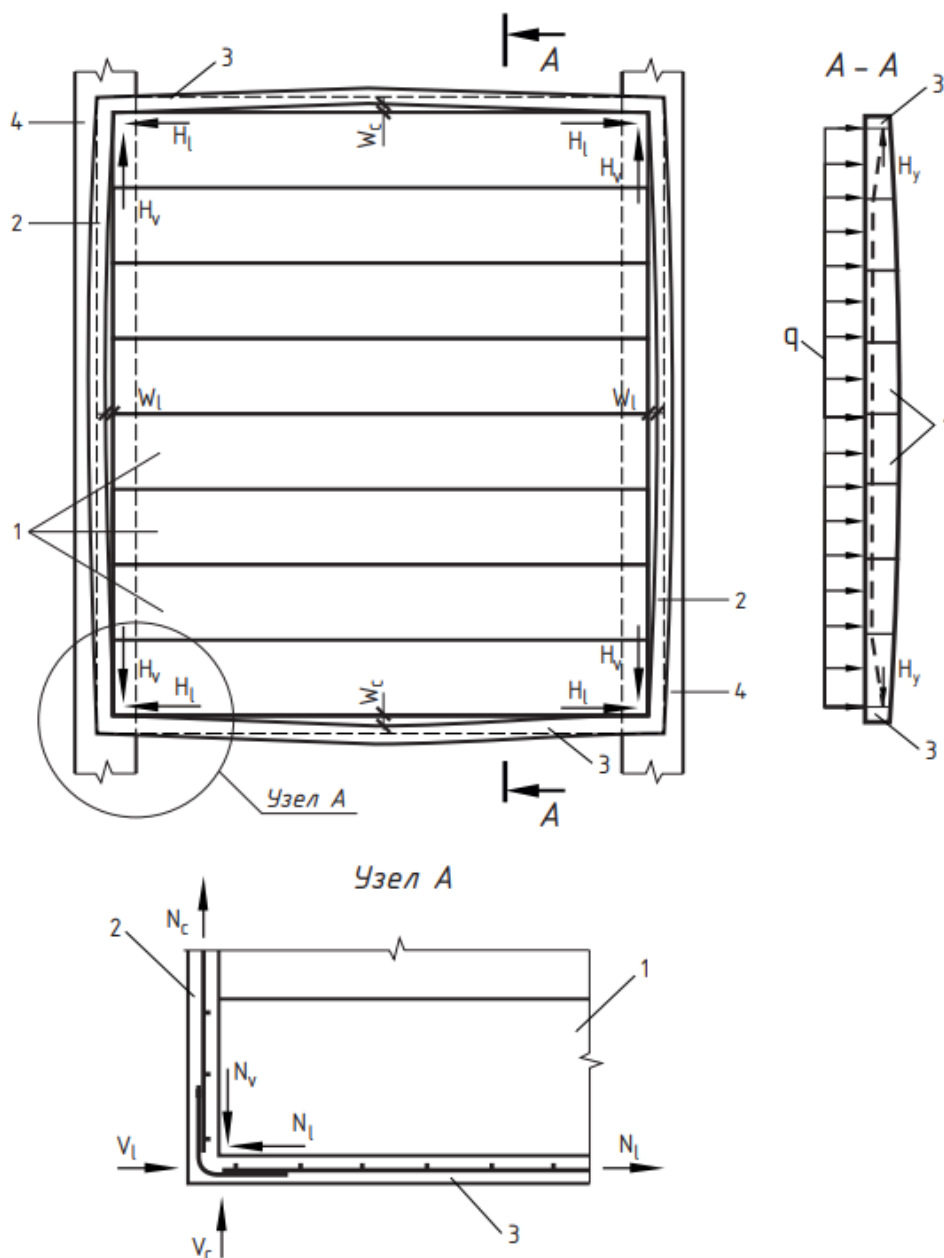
Деформированное состояние нижней грани поясов обвязочной монолитной рамы фрагмента ФП2 на предельных стадиях нагружения перед разрушением и реактивные усилия в плоскости перекрытия от действия нагрузки: 1 – ячеистобетонные плиты, 2, 3 – соответственно поперечный и продольный пояс обвязочной рамы
